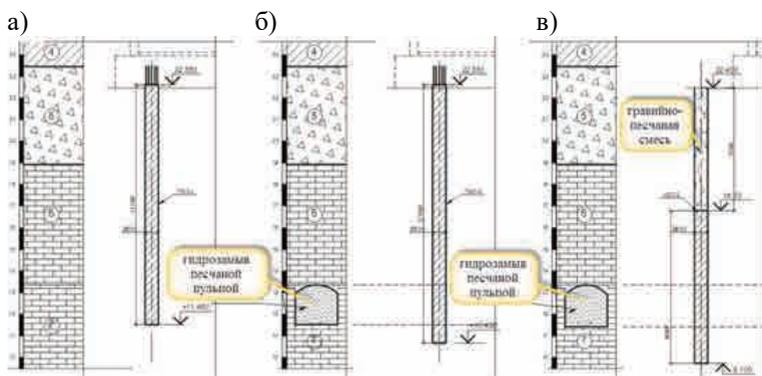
Схема устройства свай: а - рабочая свая вне зоны выработки; б - рабочая свая в зоне выработки; в - свая усиления
